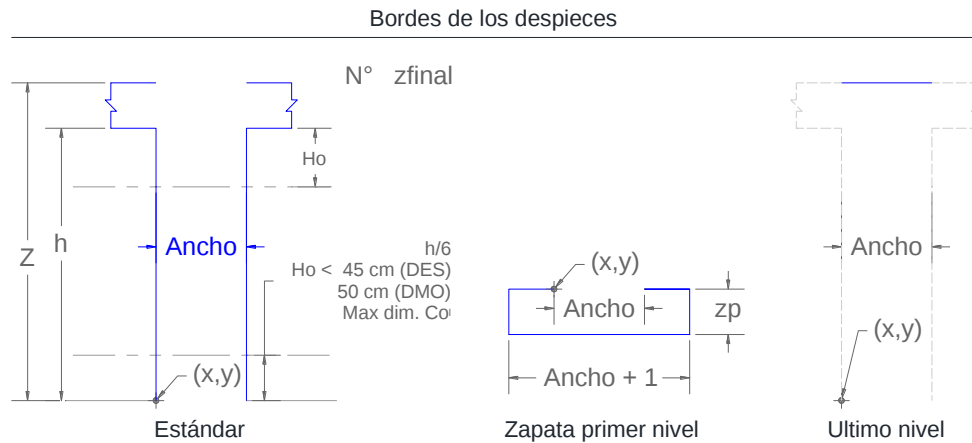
Detalle de bordes de la sección longitudinal de la columna
